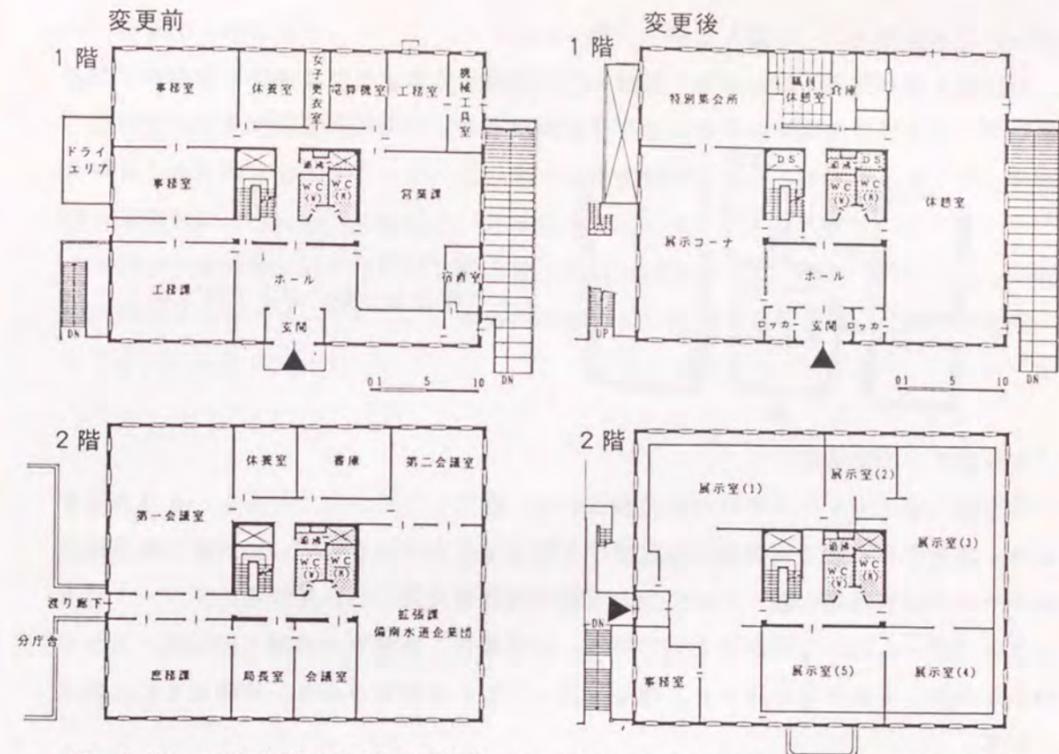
<30>倉敷市自然史博物館+観光案内所(旧水道局舎)1,2階平面図
